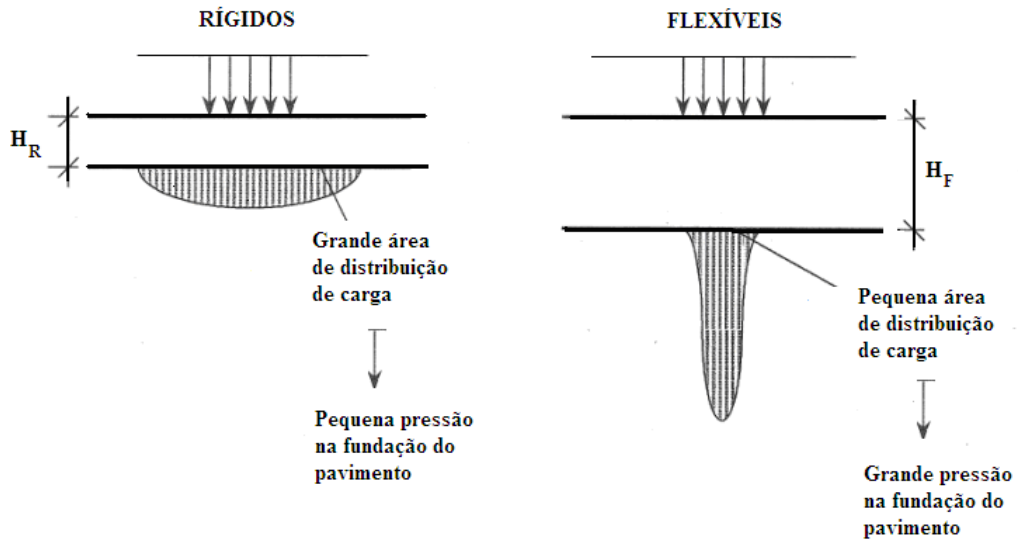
Comparação de distribuição de tensões entre pavimentos rígido e flexível
